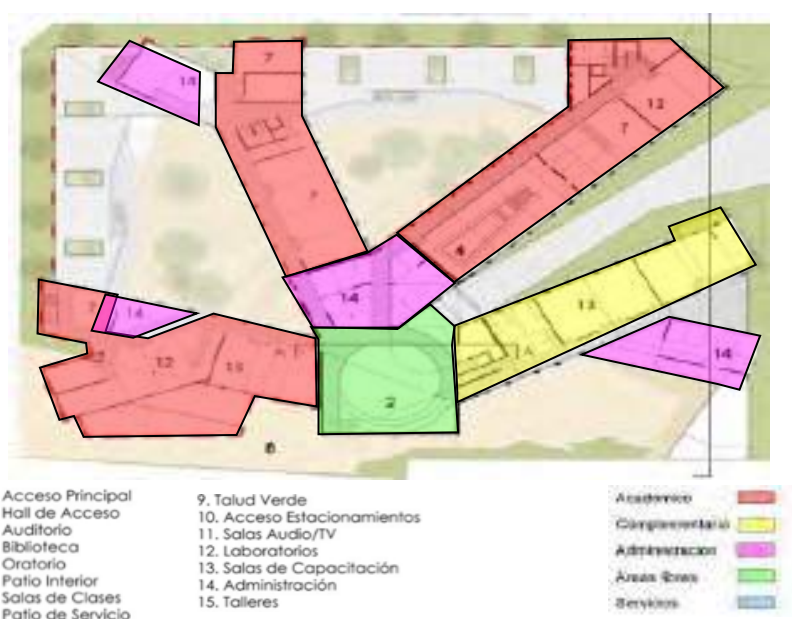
Segunda planta baja del Instituto Superior Santo Tomás
